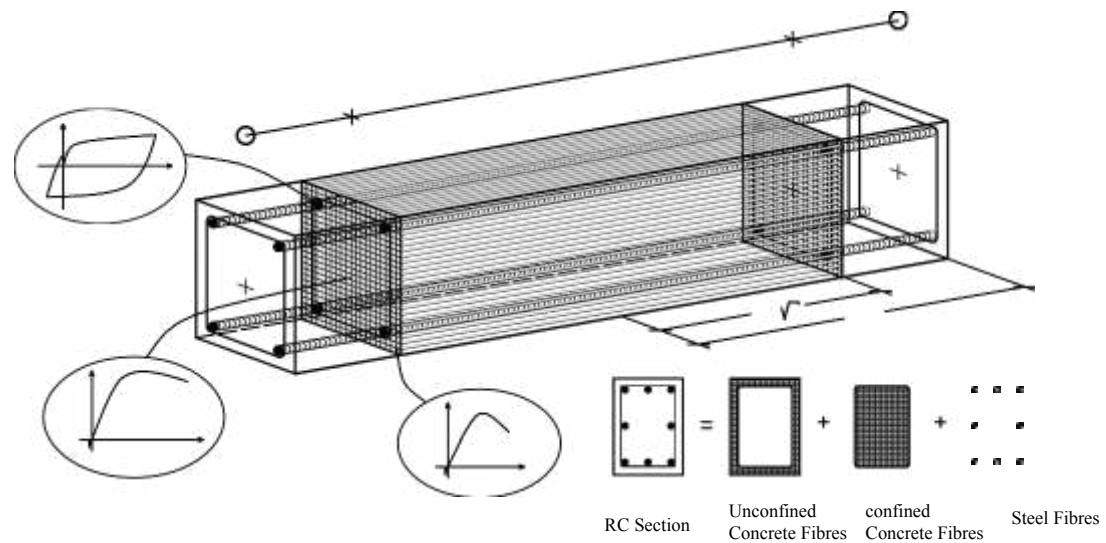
Mécanisme des fibres d'une section de béton armé (Montuori et al., 2007).
